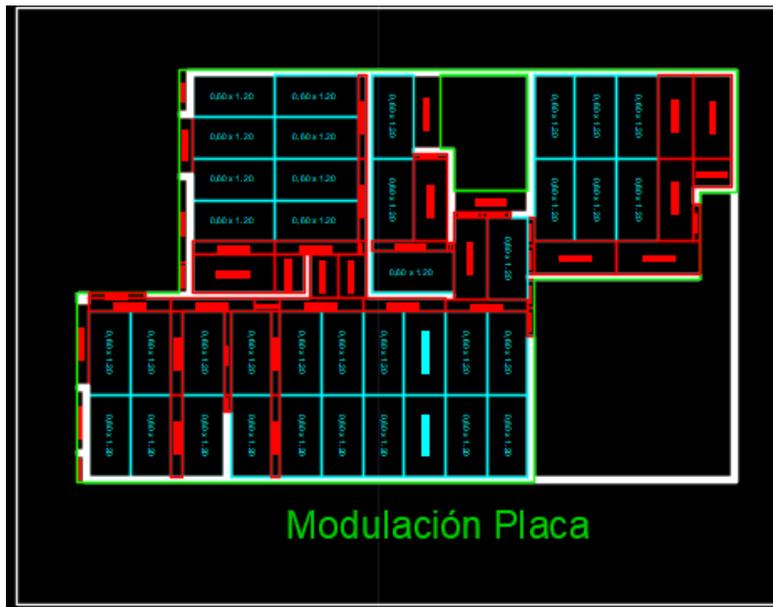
Modulación de formaleta para placa de entrepiso de proyecto a cargo de Constructora RM.
